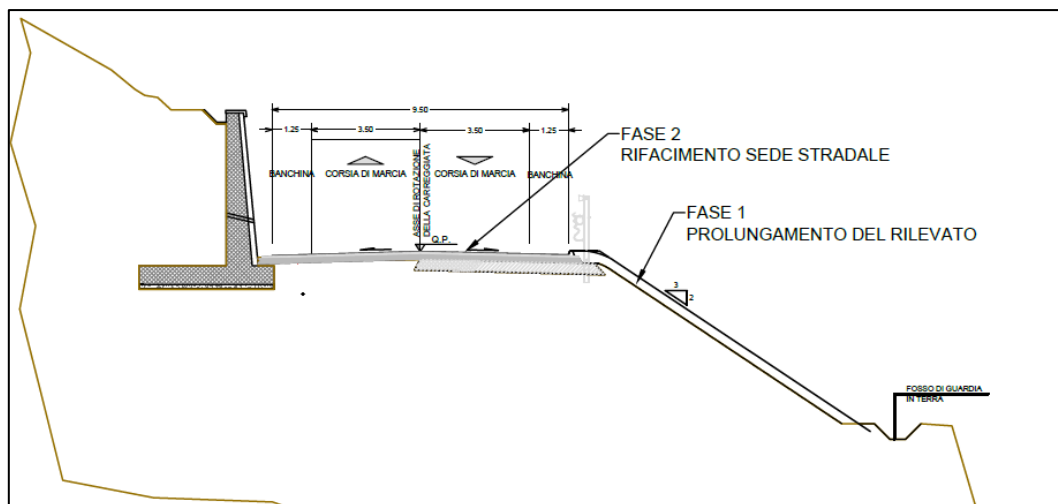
Sezione tipo 6 – Allargamento del rilevato lato valle
